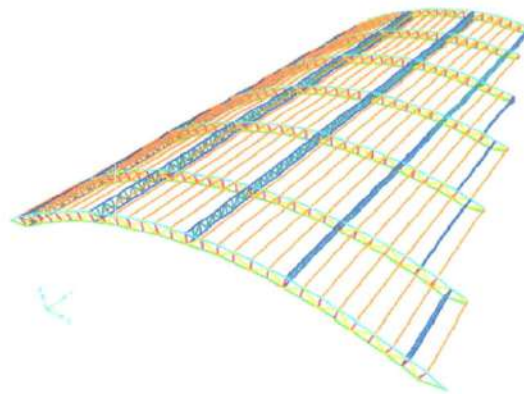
Modelamiento Estructural de Elementos Metálicos con el Software SAP2000
